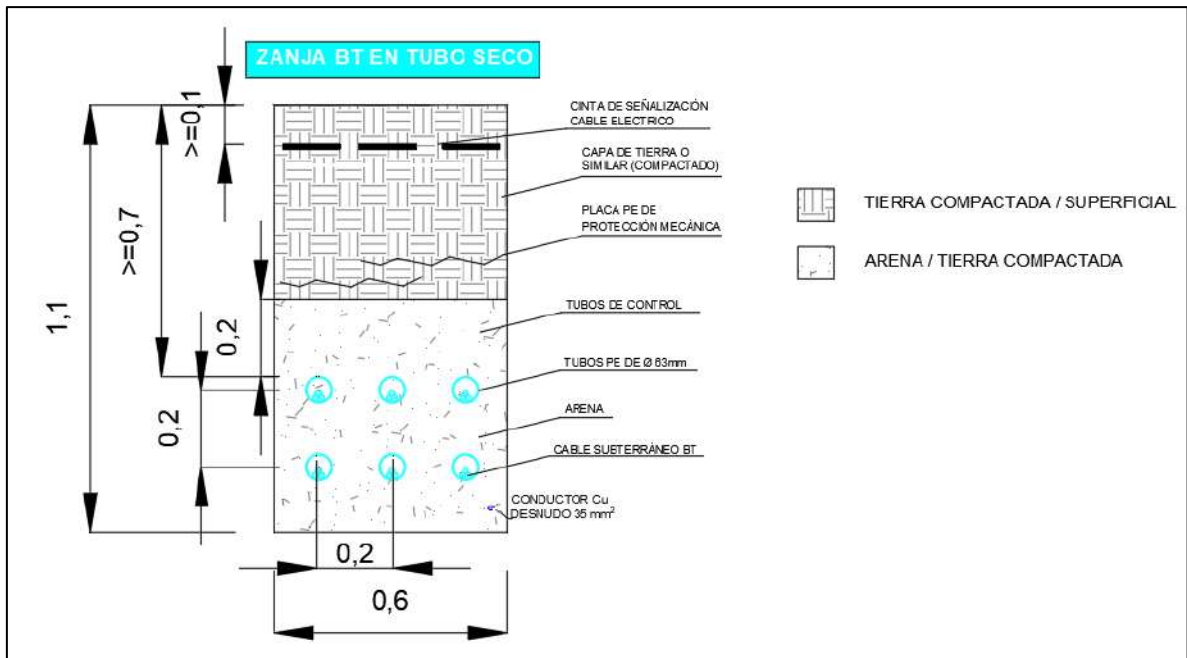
Detalle de zanja de corriente alterna en tubo seco
